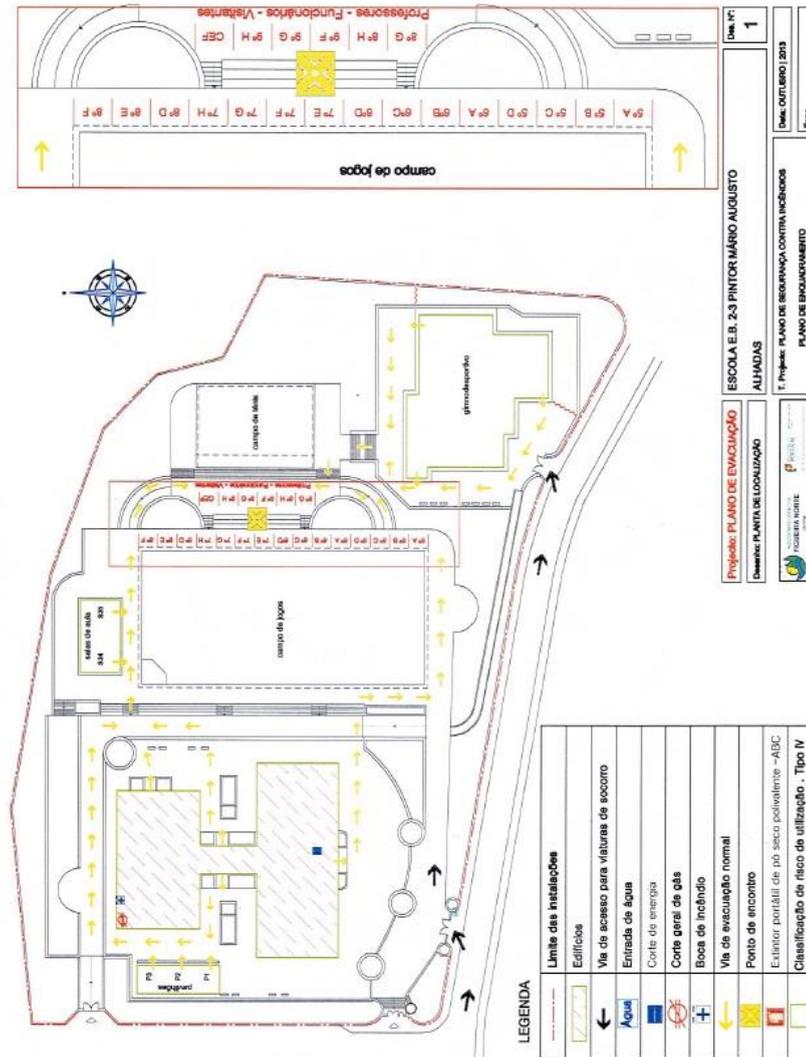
PLANTA DE CONJUNTO/LOCALIZAÇÃO
